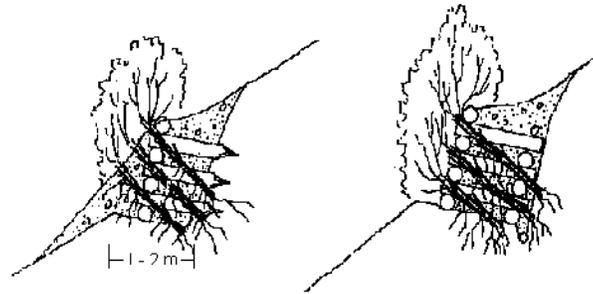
Muros de sostenimiento de madera con lechos de ramas para la estabilización del pie de una ladera
